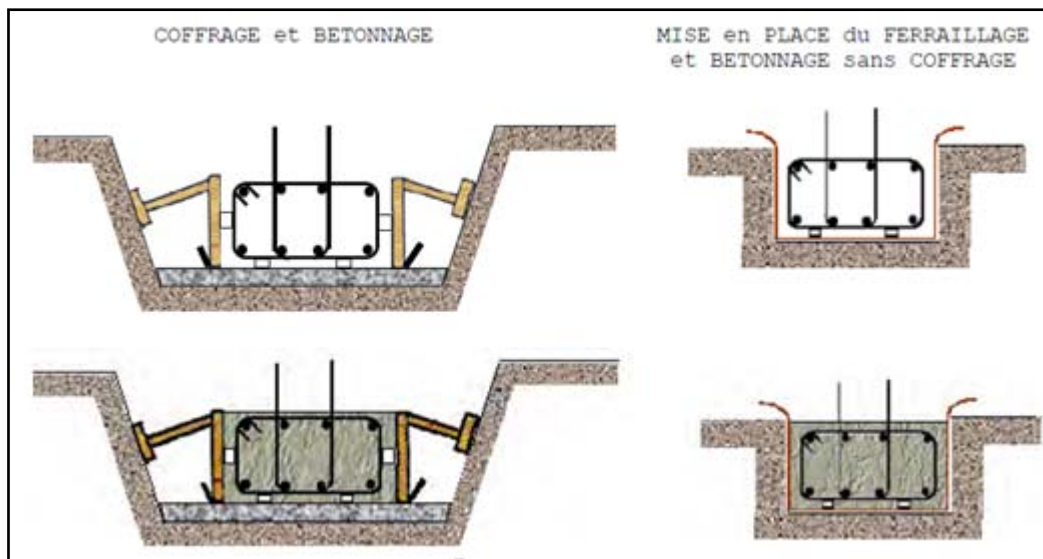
Bétonnage avec coffrage et bétonnage en pleine fouille
